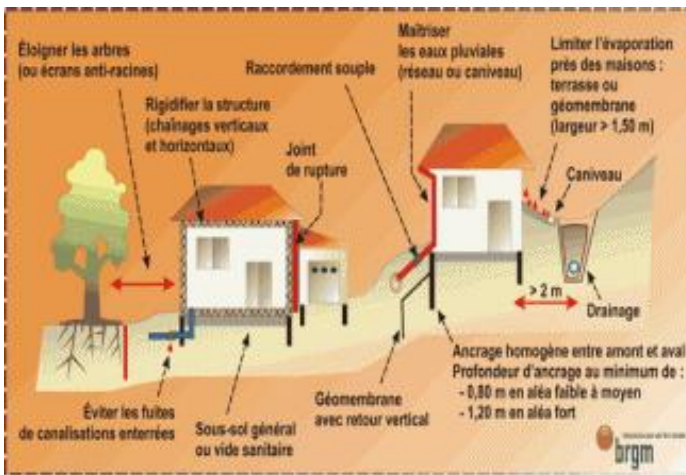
Comment construire avec l'aléa RGA (Source BRGM)
